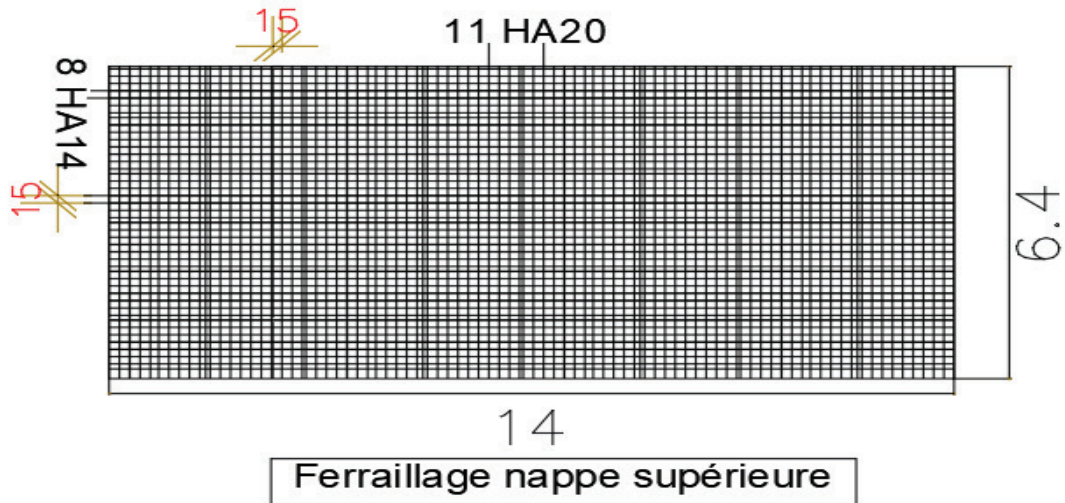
Ferrailage de la nappe supérieure de la semelle sous la pile
